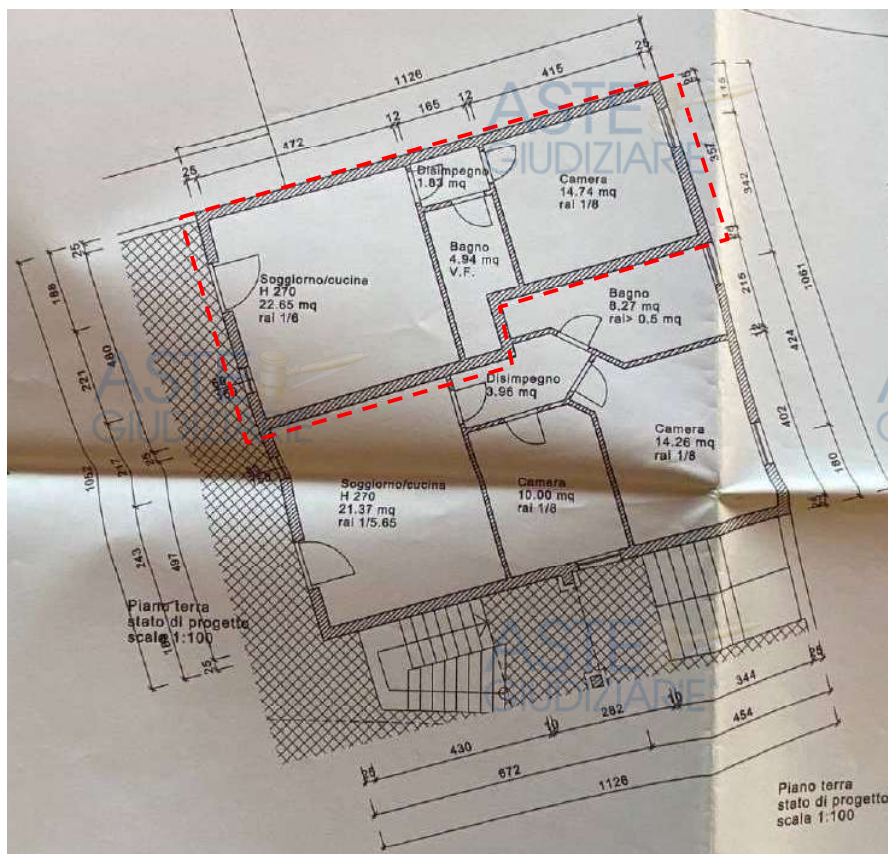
D.I.A. n. 411 prot. 37248 del 09.12.2005 – Estratto tav. 2 pianta piano terra
